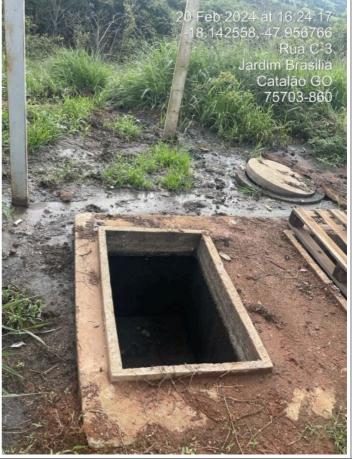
Estação Elevatória de Efluentes - EEE - Esgoto bruto à céu aberto.
